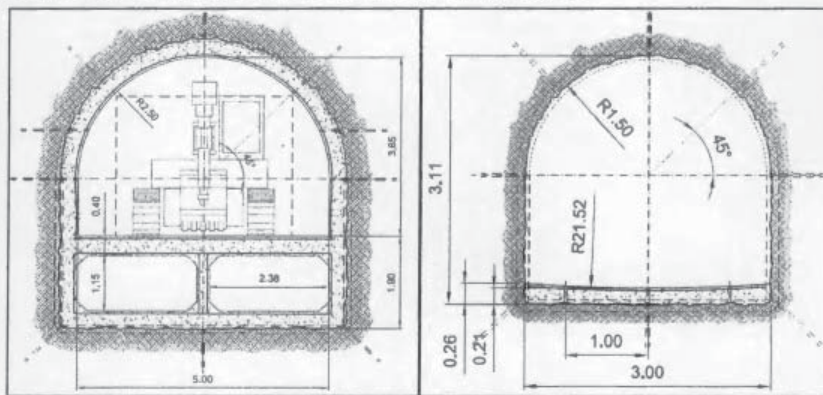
Izq.: Sección Tipo Tramo La Laguna a Vallecito – Der.: Sección Tipo Tramo Vallecito a Presa
